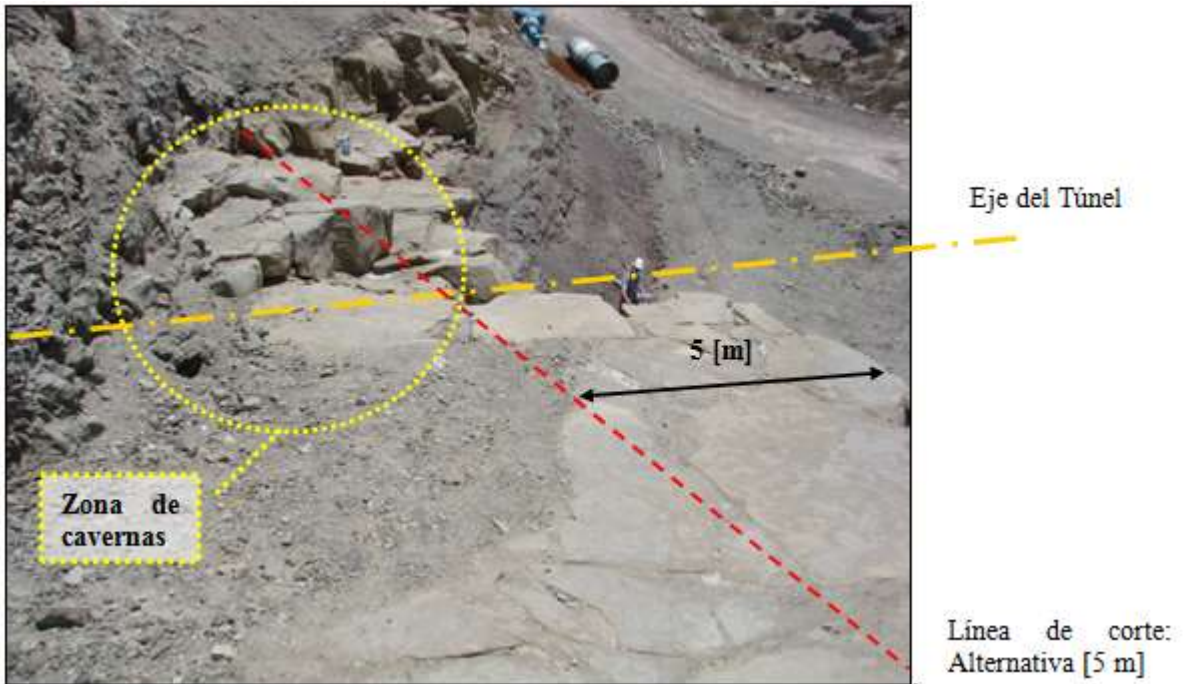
Se observan las fisuras y oquedades sobre la berma, rellenas con mortero.
